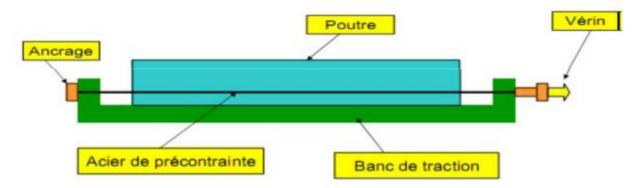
Coupe longitudinal d'une poutre en béton précontraint par pré-tension
